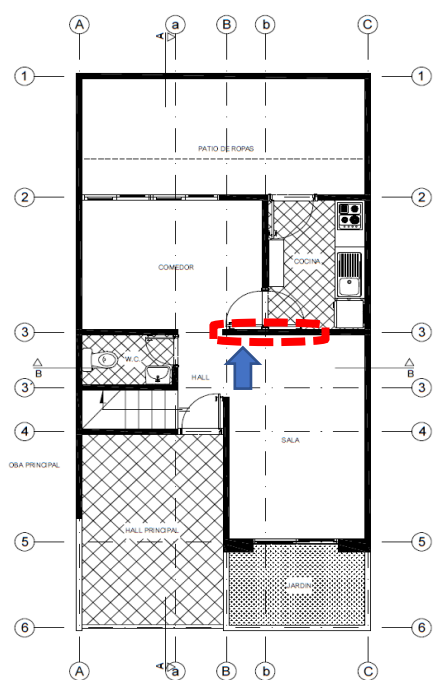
Grieta en muro de la sala. Fuente propia 2017.
